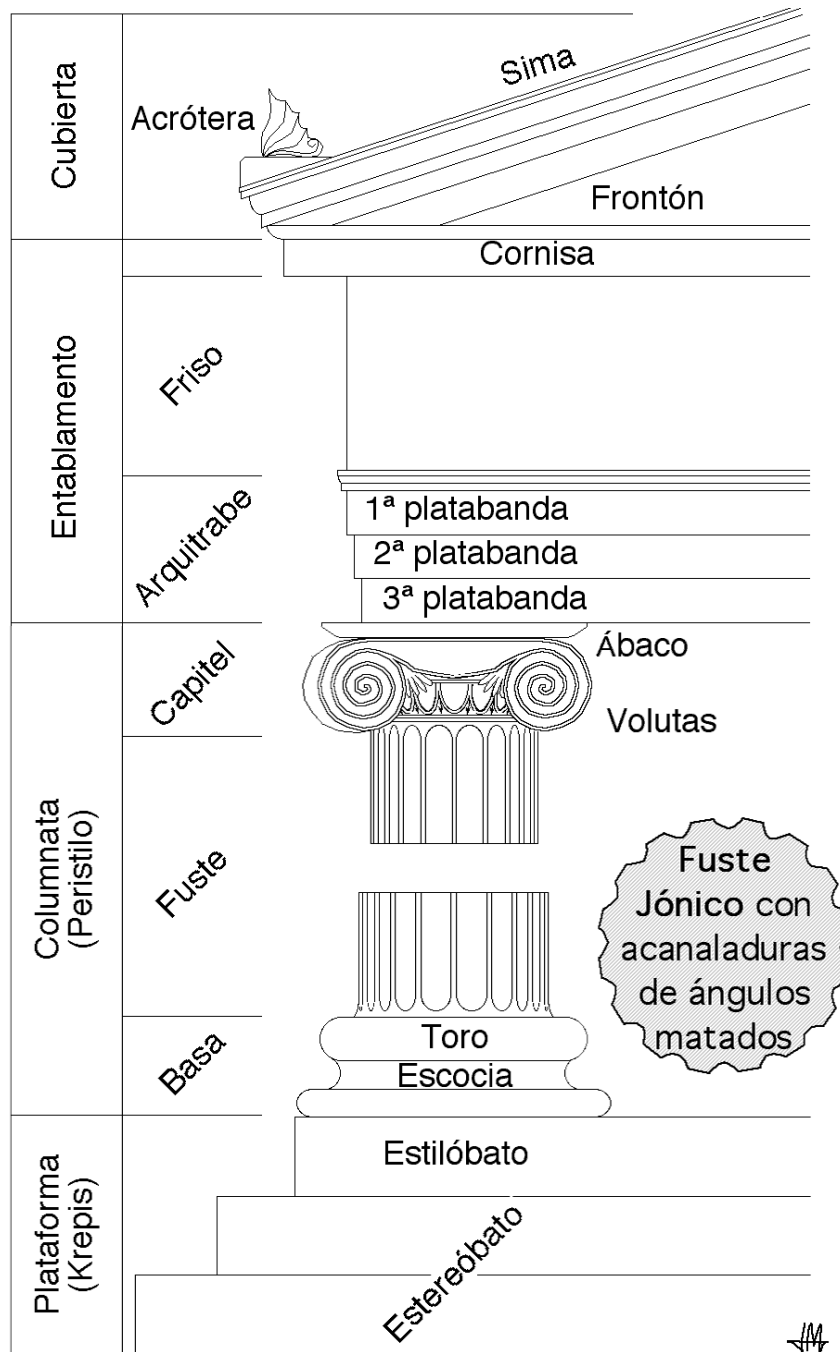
A): Alzado con frontón (frontis) reconstruido de Orden Jónico.
